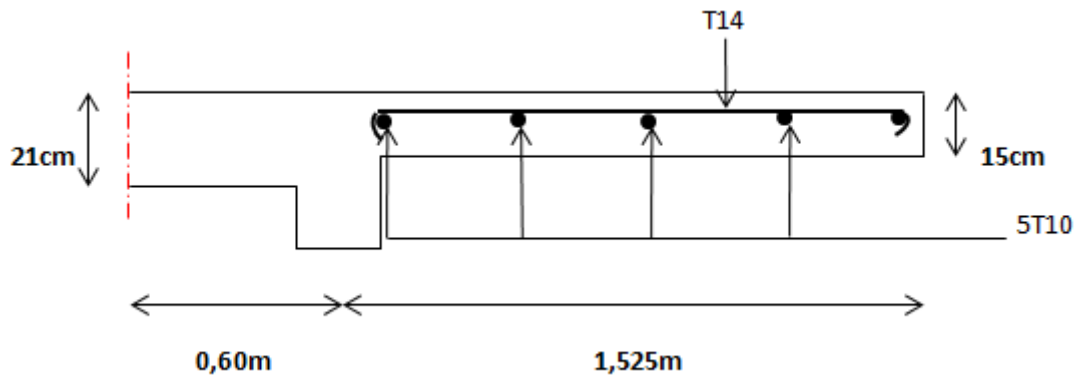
Ferrailage de la dalle pleine de séchoir type 1.
